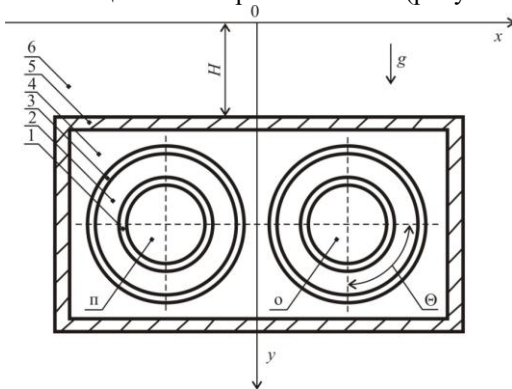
Схема области решения: 1 – труба; 2 – тепловая изоляции; 3 – покровный слой; 4 – полость канала; 5 – стенка канала; 6 – грунт; п – подающий трубопровод; о – обратный трубопровод
